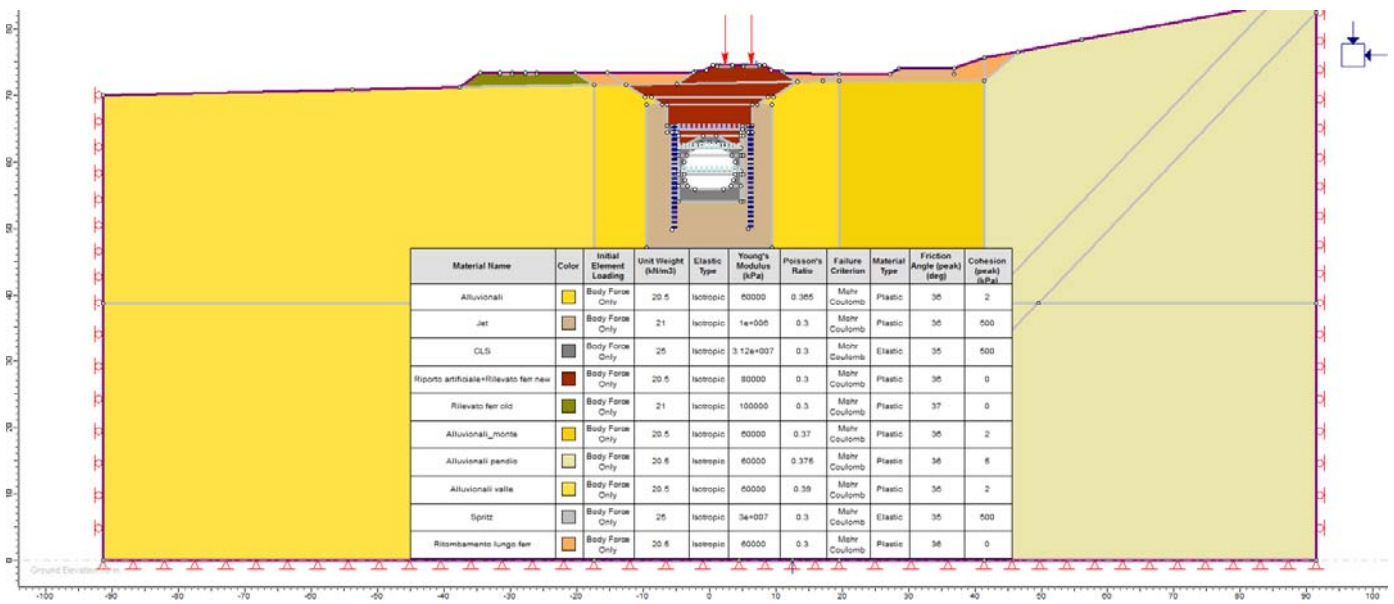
Galleria Binario Pari. Assestamento del rilevato della Linea Storica spostata, sezione pk 0+425. Geometria di calcolo
